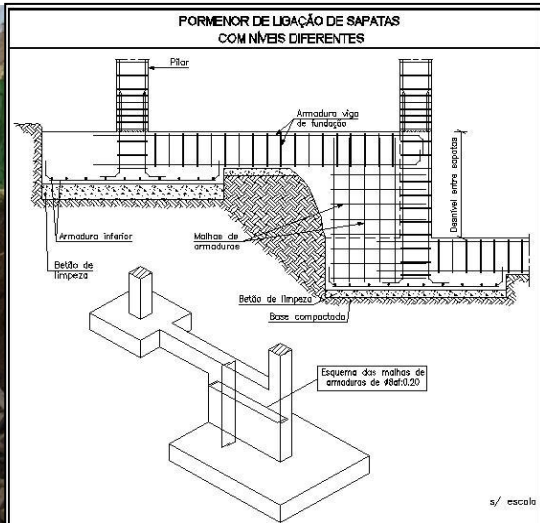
Pormenor de ligação entre Sapatas desniveladas
